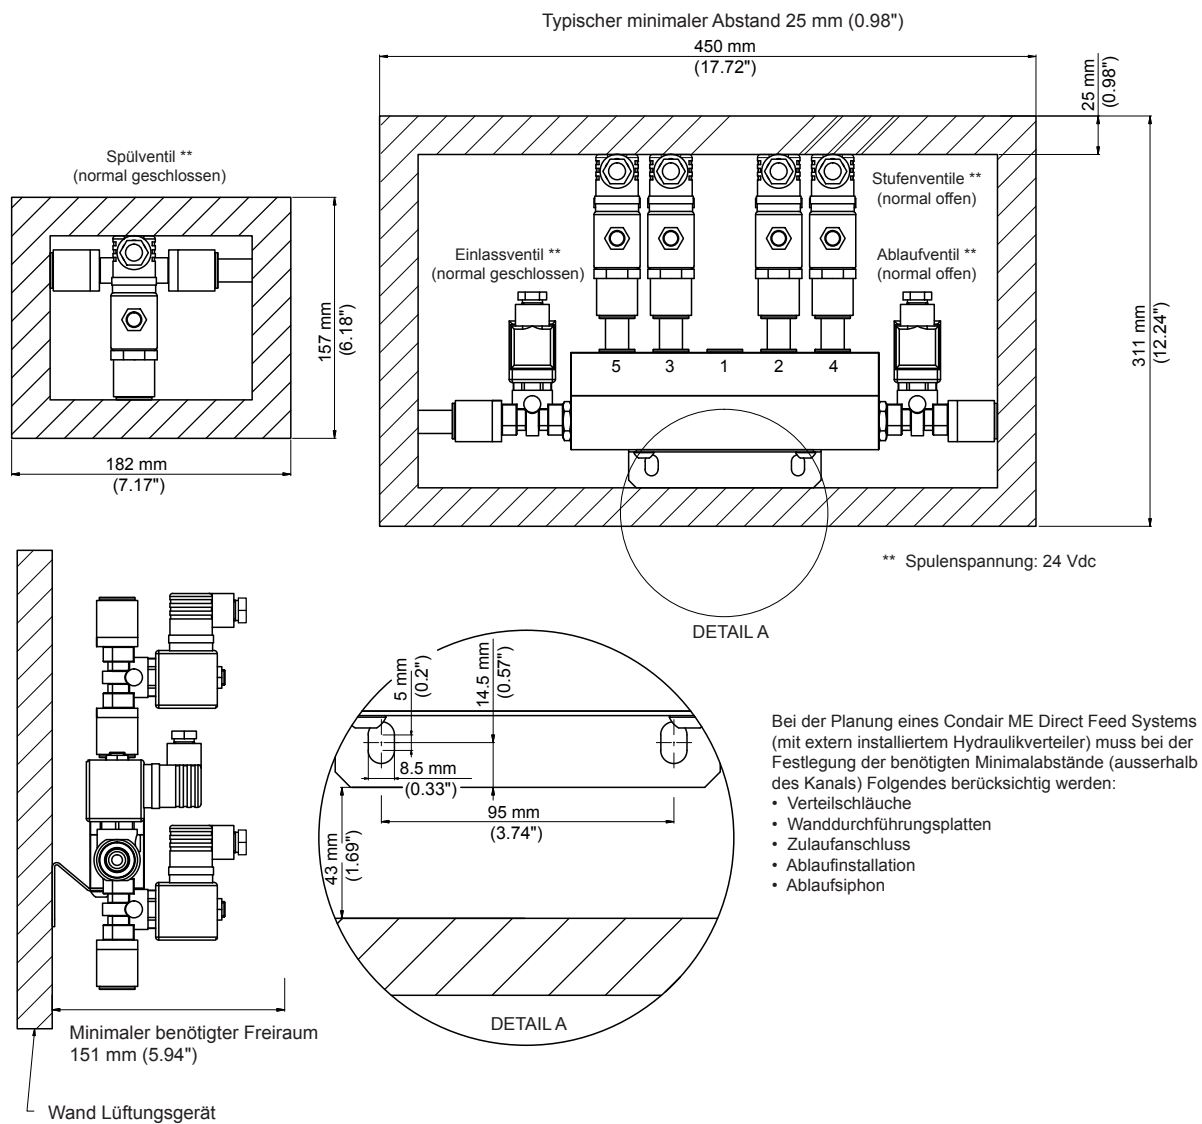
Masse/Minimalabstände Hydraulikverteiler Condair ME Direct Feed (Aussenmontage)
